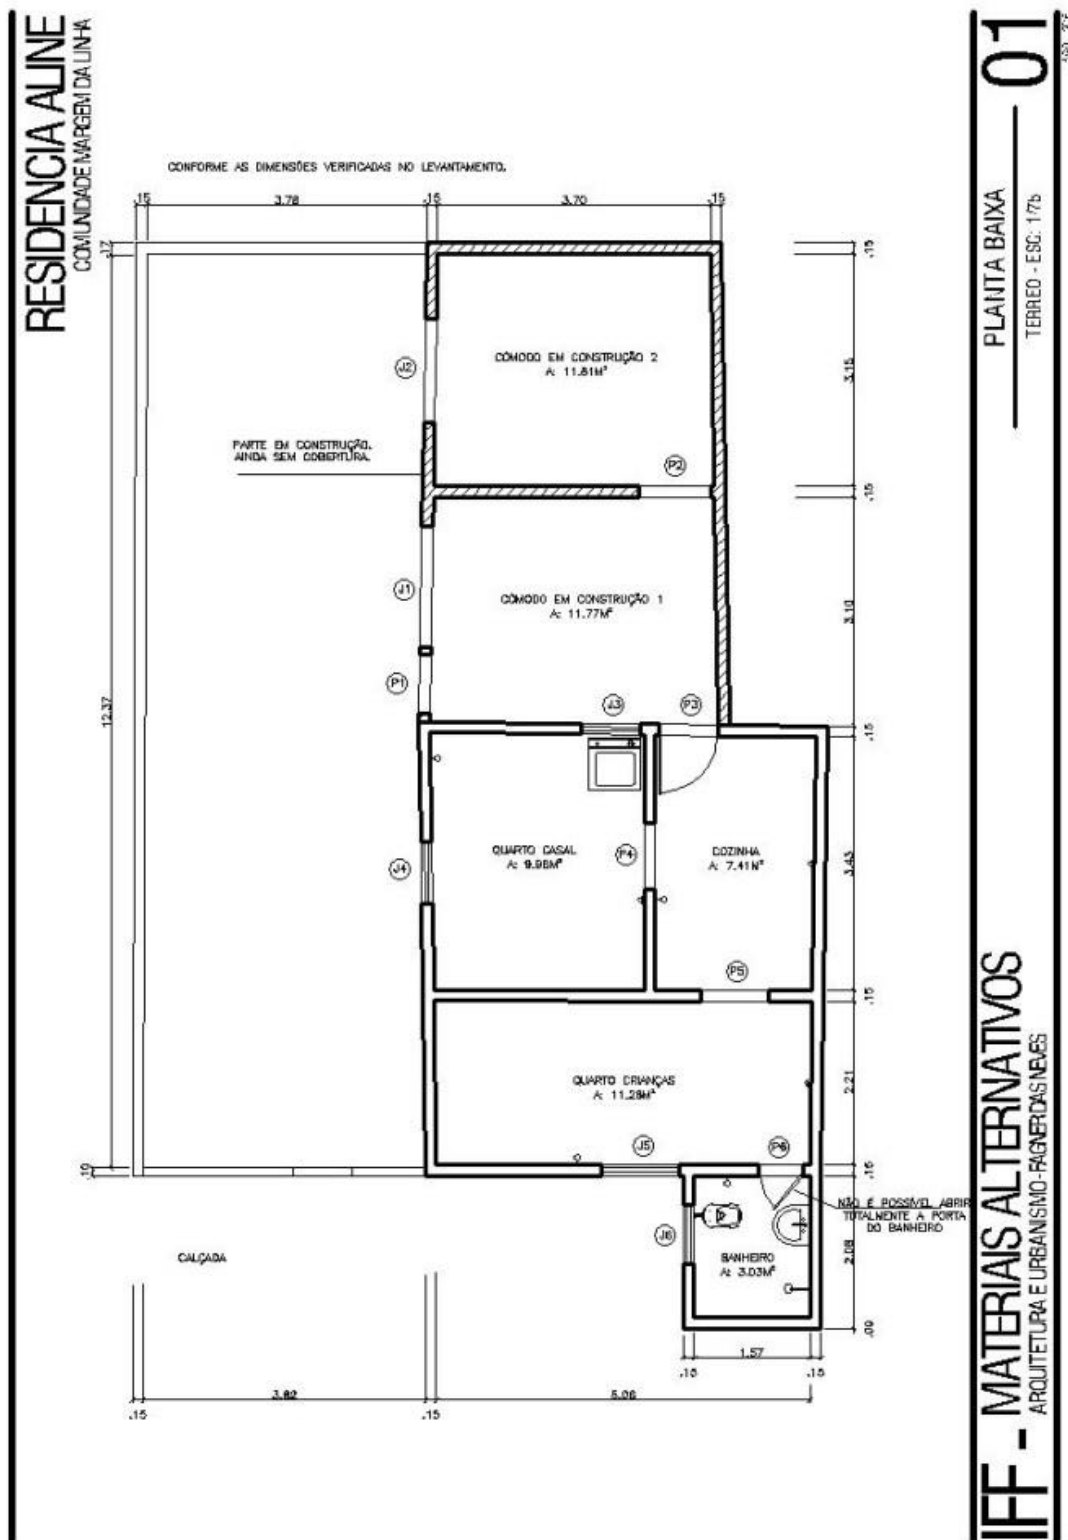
Planta baixa do levantamento técnico da residência para intervenção.
